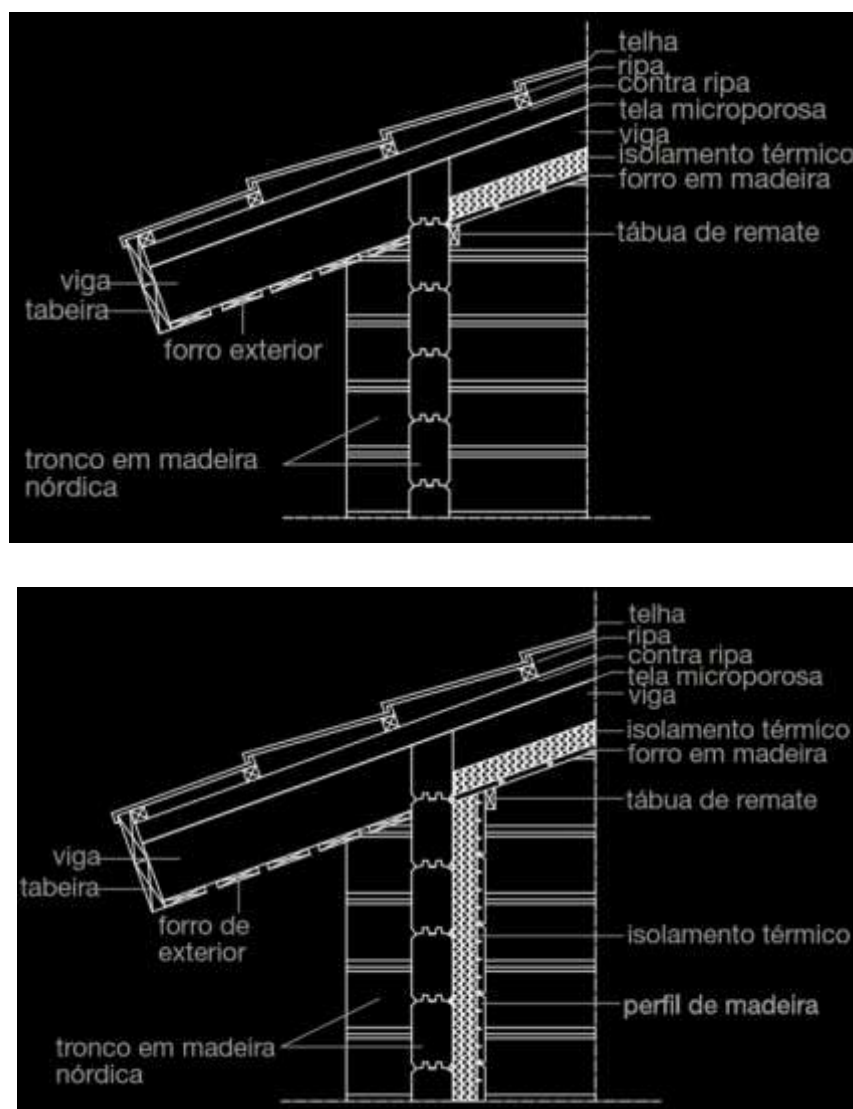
Sistema construtivo Blockhouse: em cima parede simples e em baixo parede dupla (TOSCCA, 2012)
